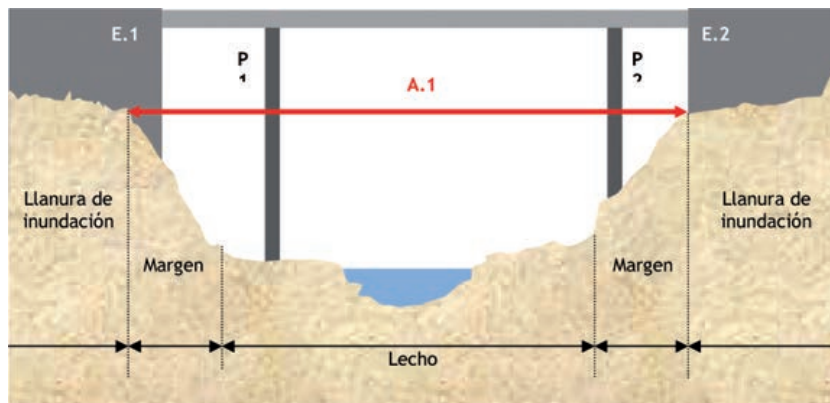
ANCHURA DEL CAUCE.
